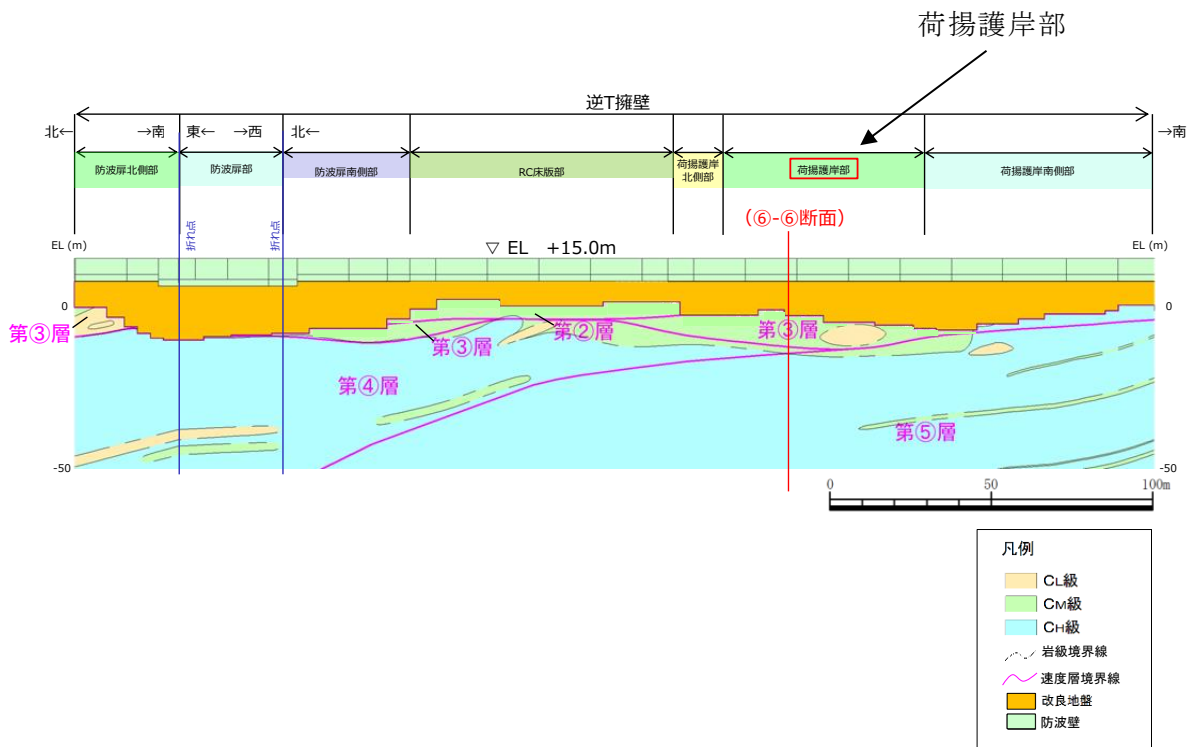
(1) 防波壁（逆 T 擁壁）の地質縦断面図（岩級図）
